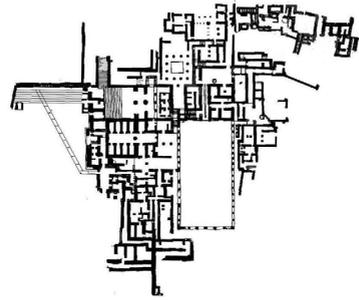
Festo, Creta. Pianta delle strutture minoiche.
